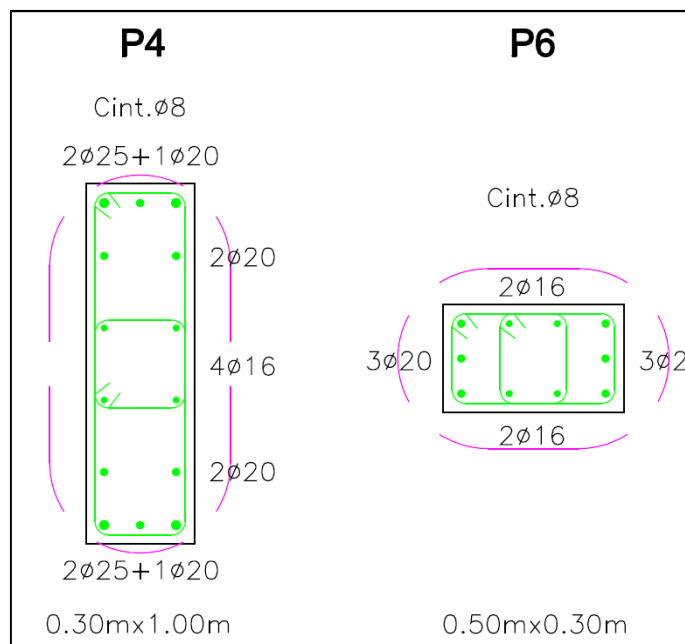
Pormenorização transversal dos pilares P4 e P6
